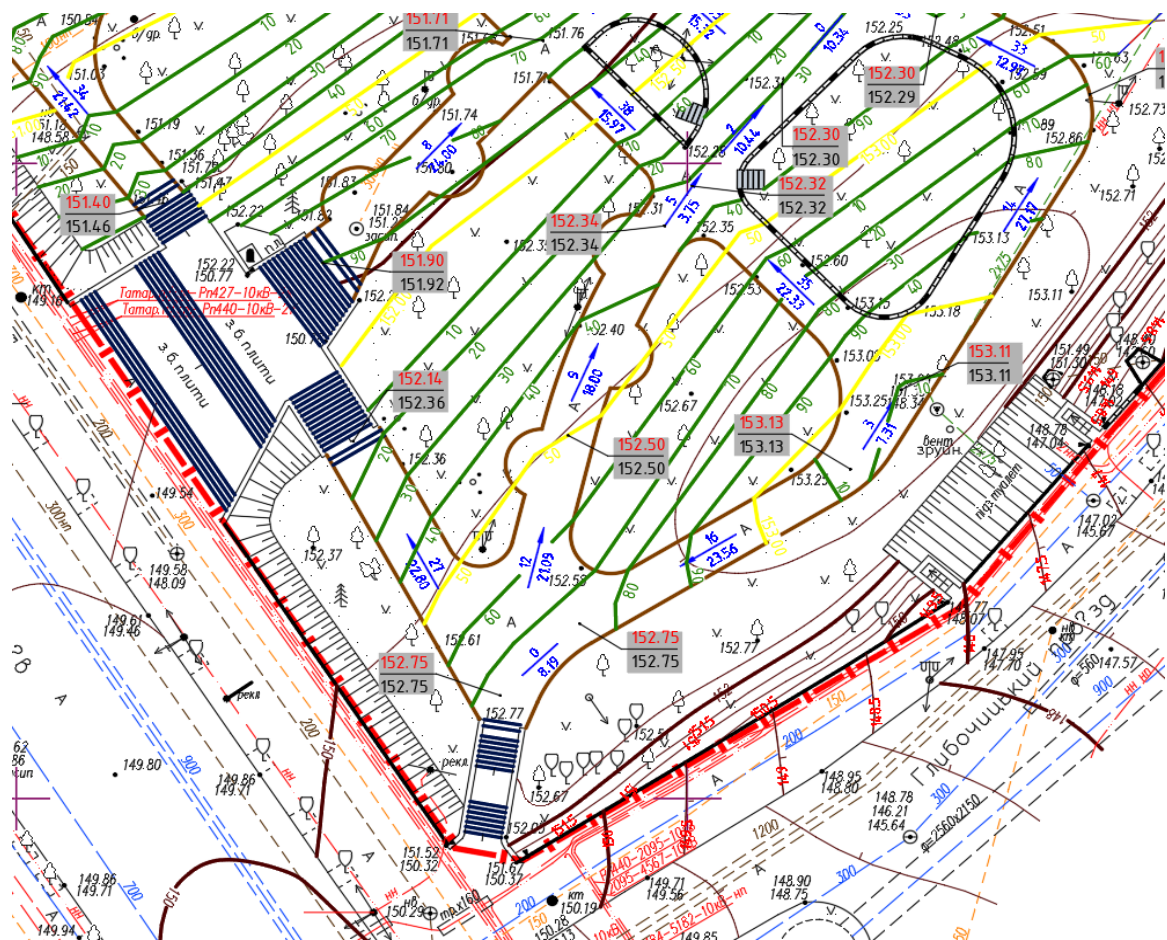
Схема вертикального планування території міста (фрагмент)
